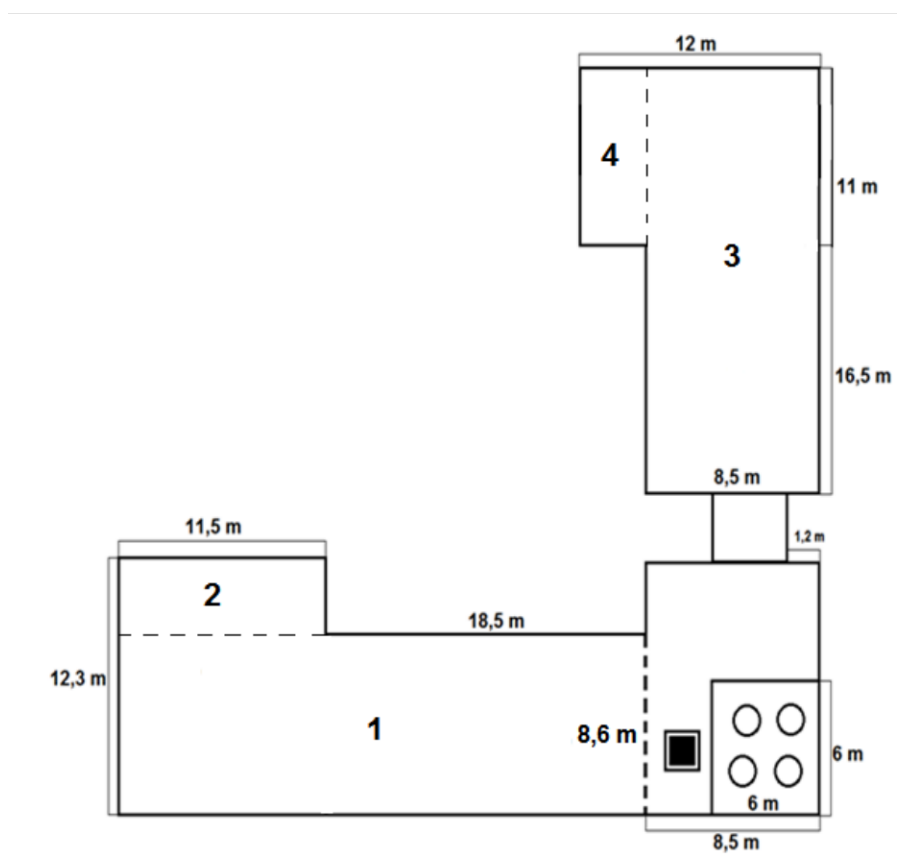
Áreas disponibles donde se instalarán los paneles. Fuente: Autores.
